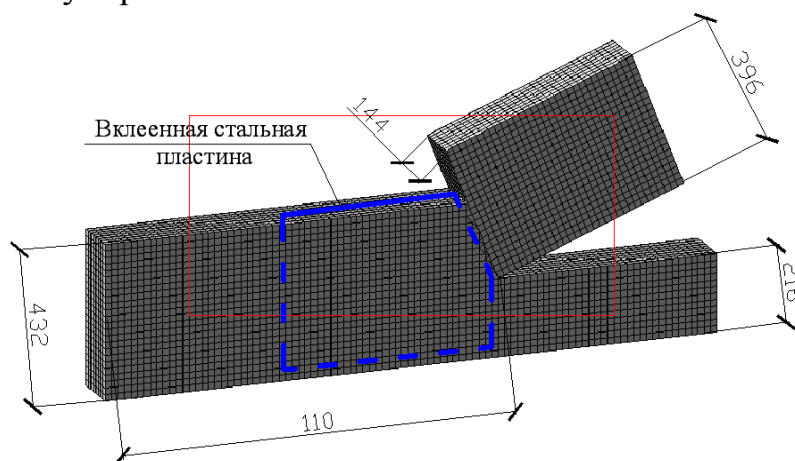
Расчетная модель опорного узла треугольной фермы с вклеенной в нижний пояс стальной пластиной
